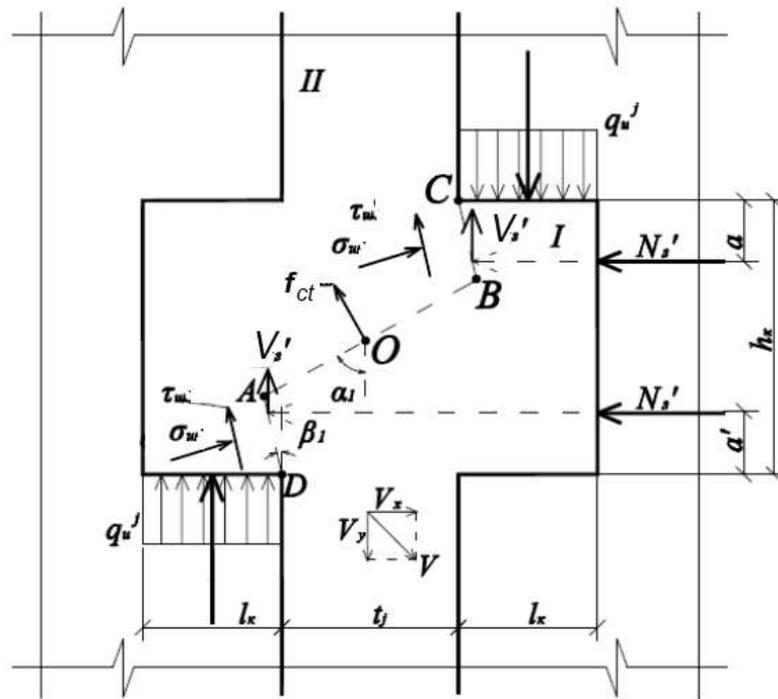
Кінематично можлива схема руйнування шва в одношпонкових стиках із прямокутним профілем із розташуванням арматури у два яруси і врахуванням нагельного ефекта в усій арматурі
